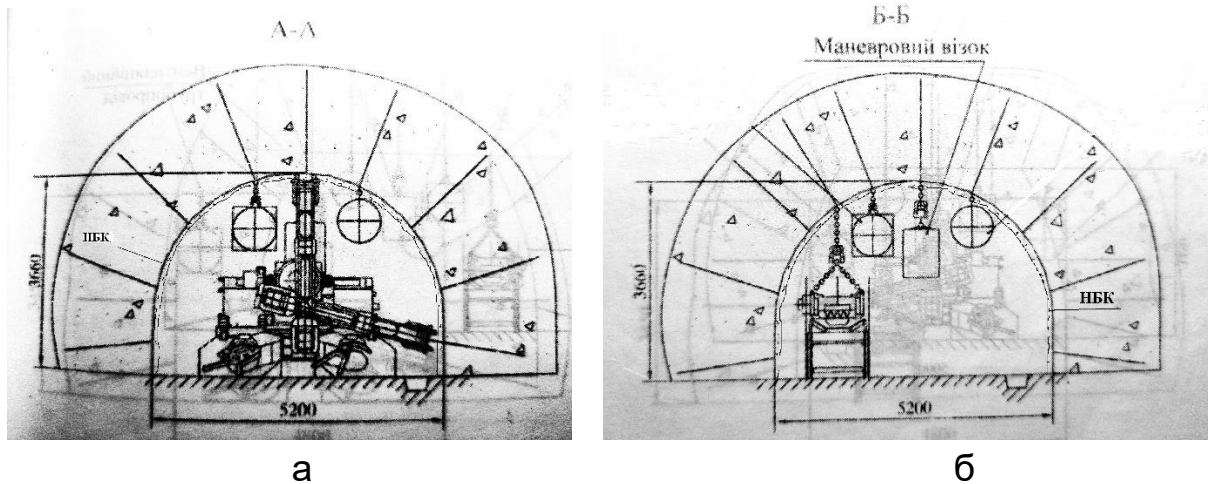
Перетини виробки аркової форми з анкерно-набризкбетонним кріпленням
